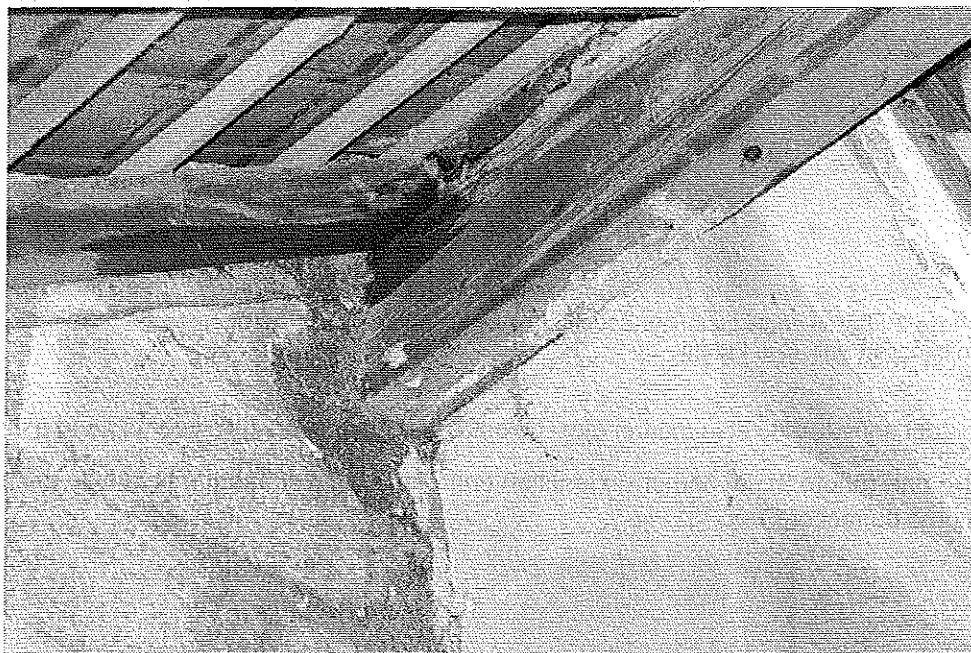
Pénétration d'eau près d'un conduit et d'un pignon. Mouillage des bois de charpente. © J. Putatti
